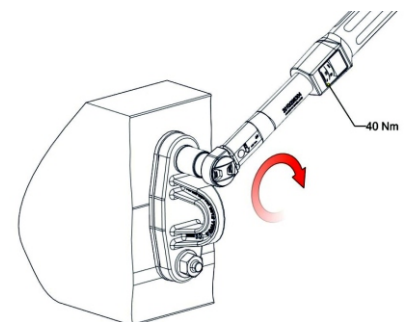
Introducción de los anclajes segmentados en el hormigón.
